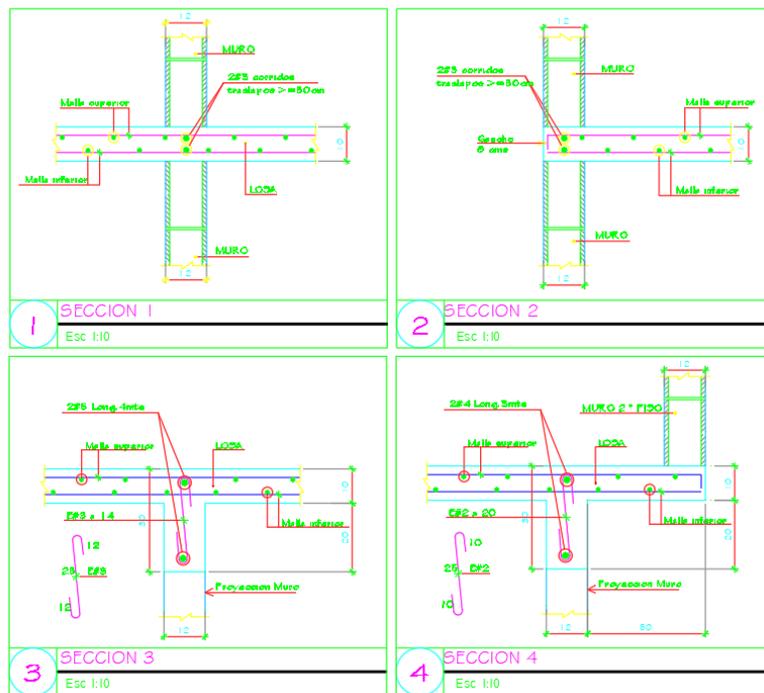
Detalles de refuerzo en esquinas losa de entrepiso
